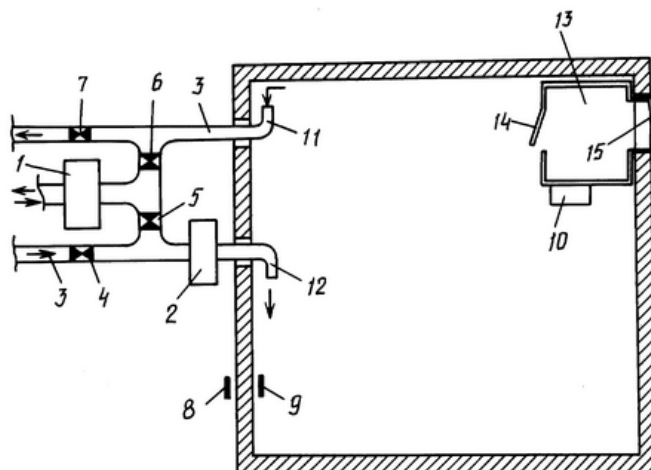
Общий вид устройства, установленного в помещении со шлюзовой камерой
